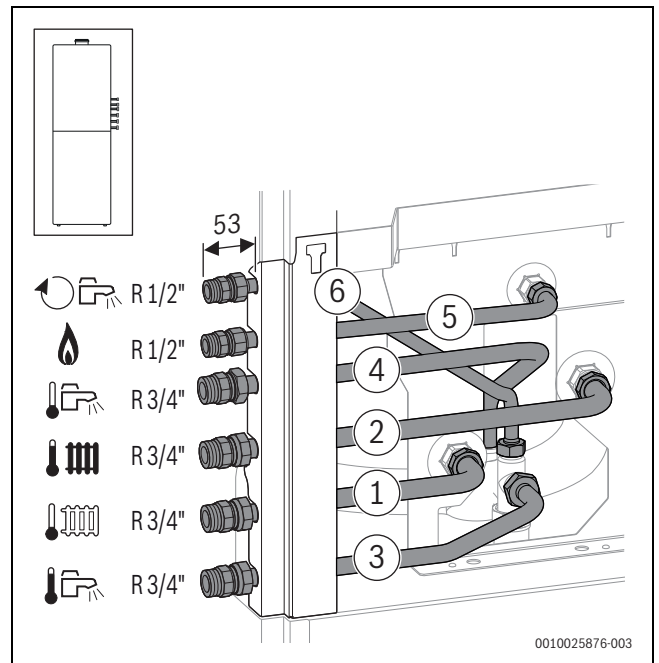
Vedere din spate (dimensiuni în mm): accesorii CS 10 montate pe partea dreaptă
